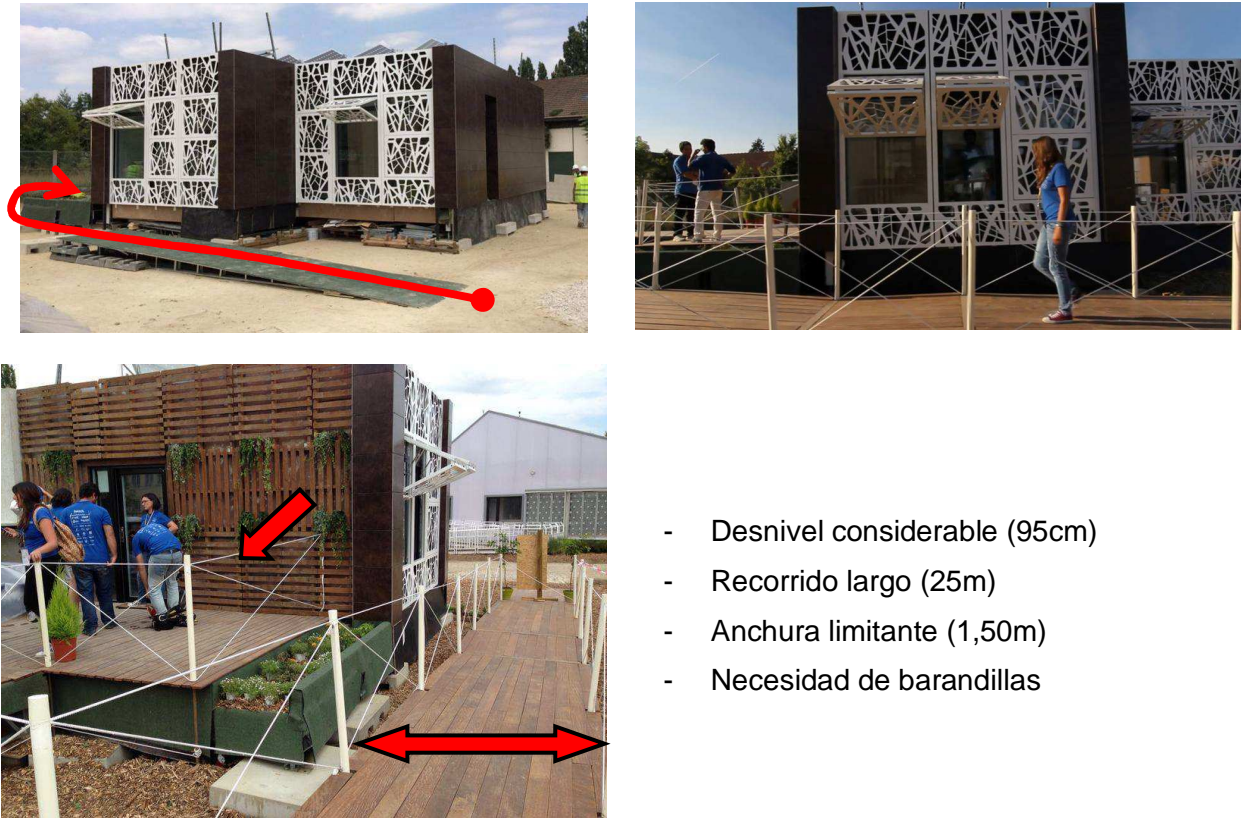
Características desfavorables de la rampa de éBRICKhouse 2014 / [equipe VIA-UJI]
